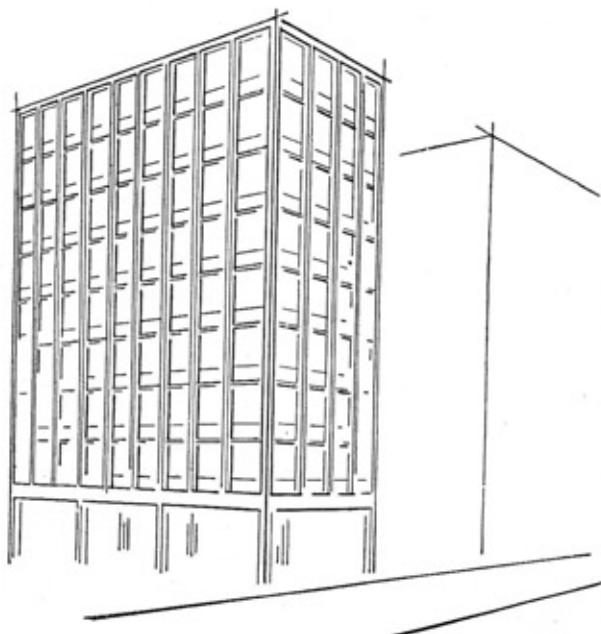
Основное различие между зданиями со сплошными стенами и зданиями каркасной конструкции проявляется главным образом в решении плоскости фасадов и их завершений
